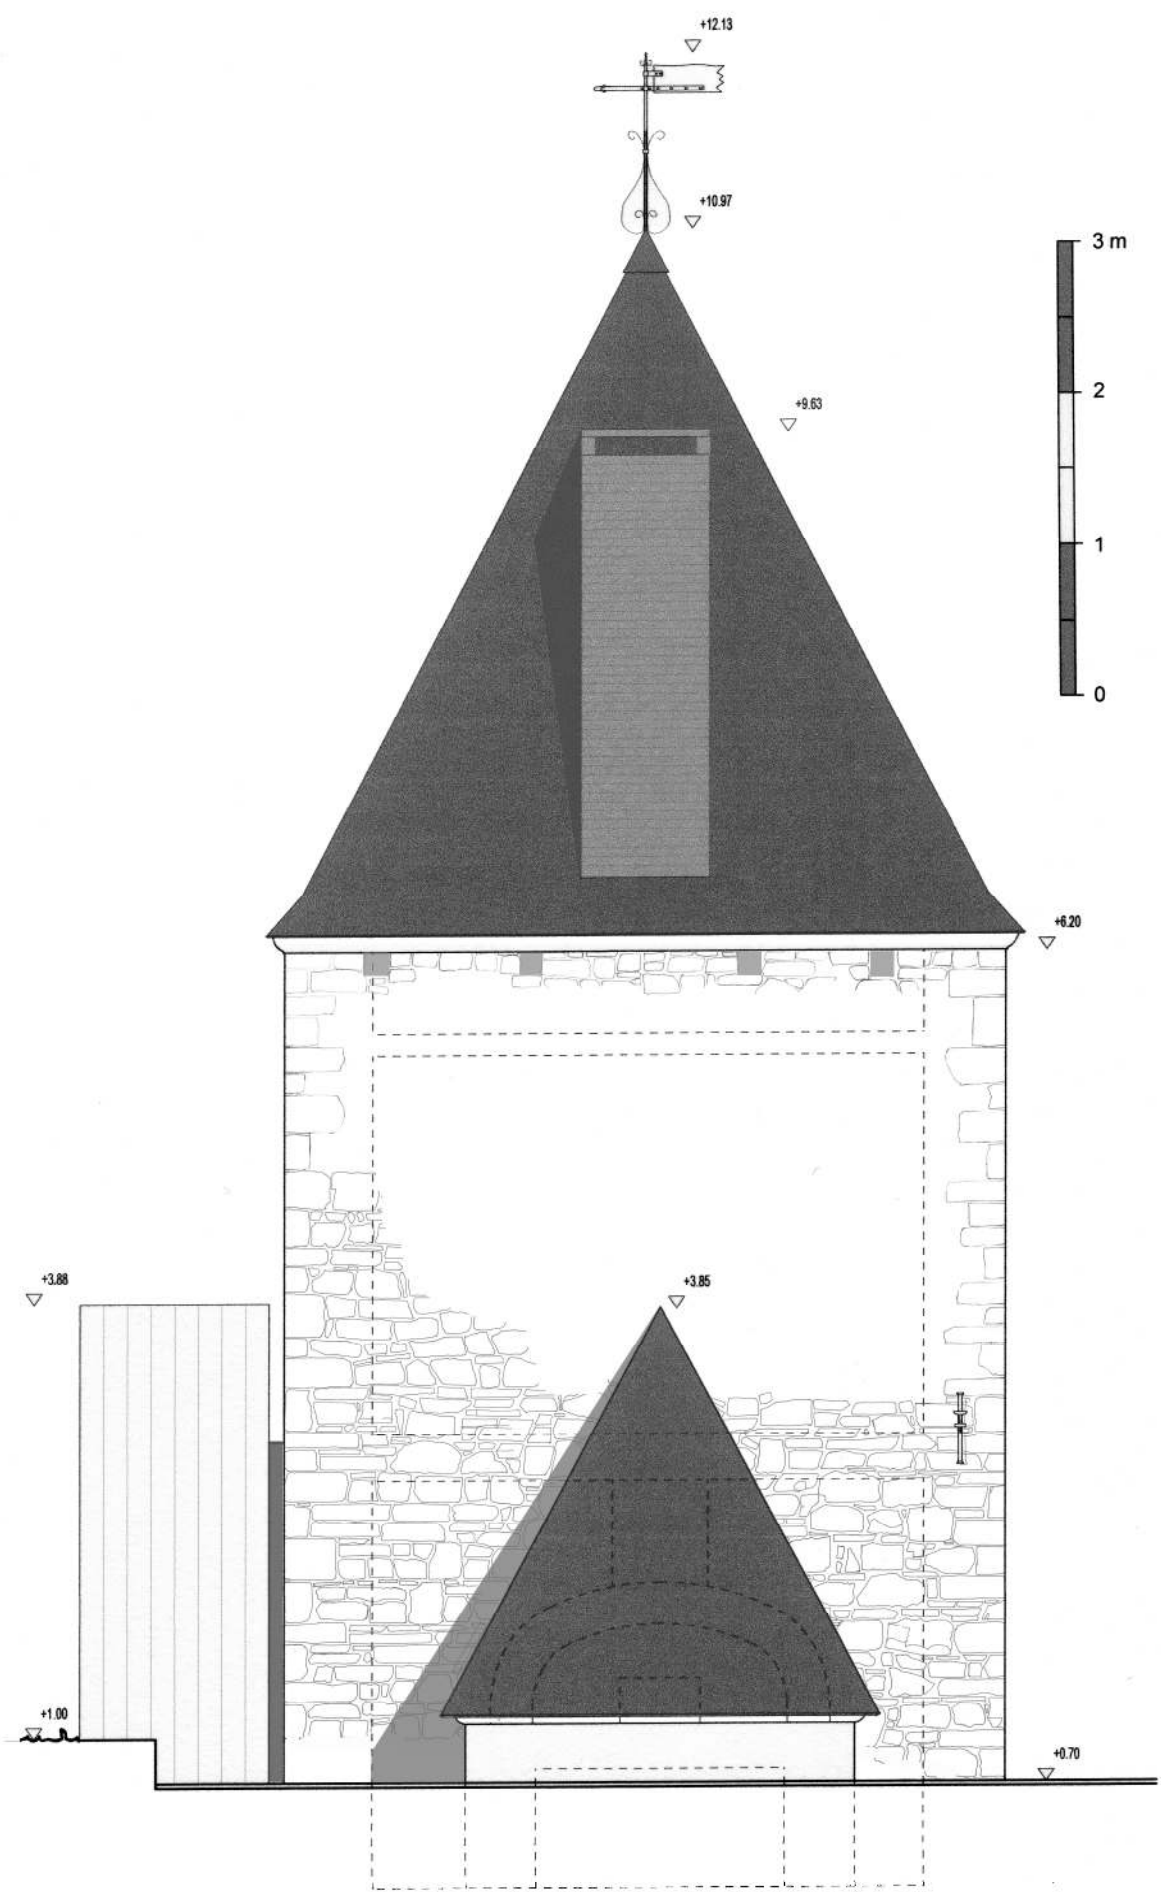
Pavillon. Elévation SE. Ech. 1/50^e. Situation projetée. IG 2008.
